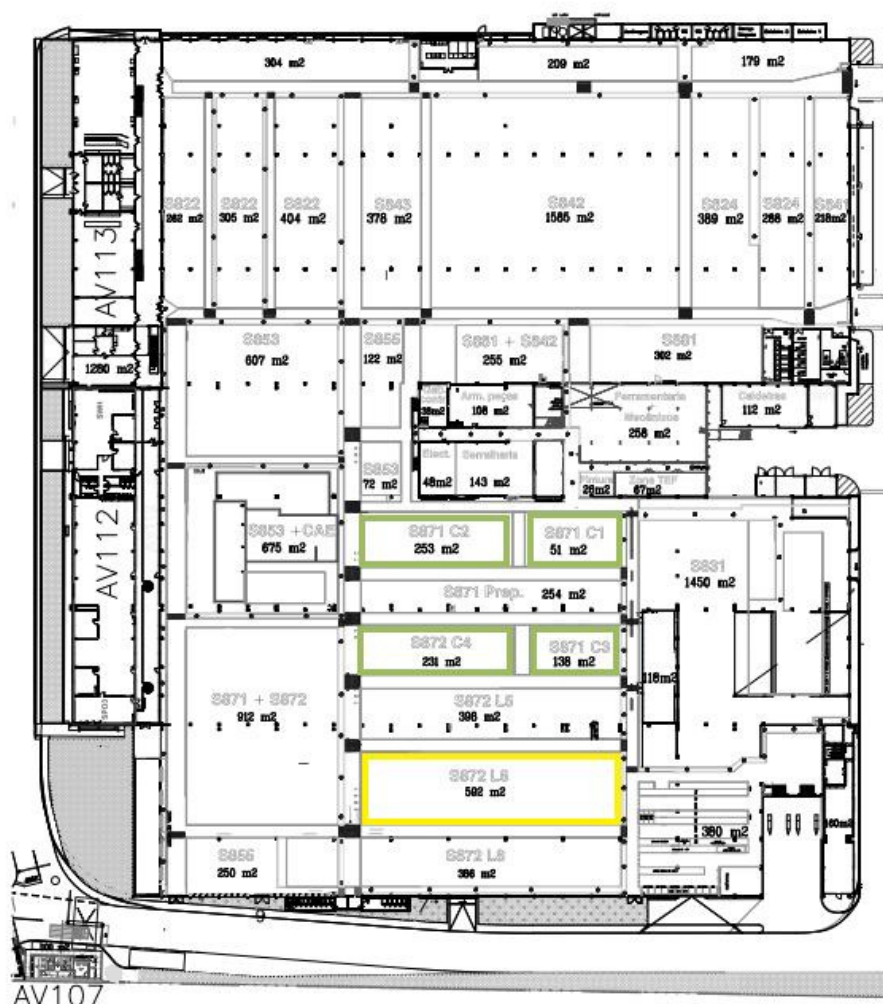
Planta do edifício de produção da *Bosch Termotecnologia S.A.
